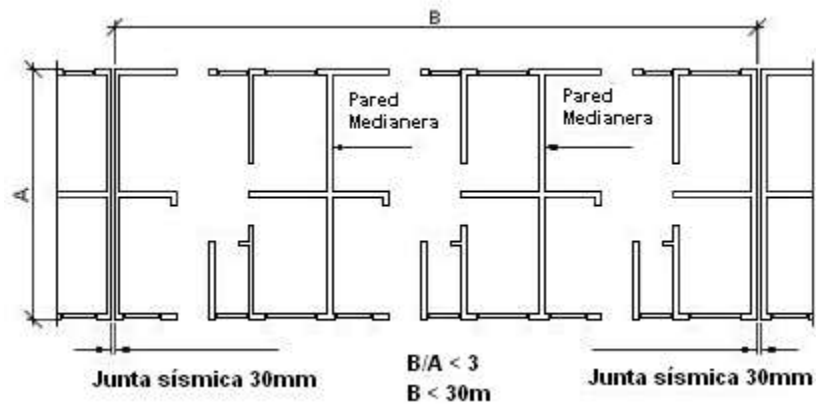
Dimensiones requeridas en planta para seguridad estructural de la vivienda.
